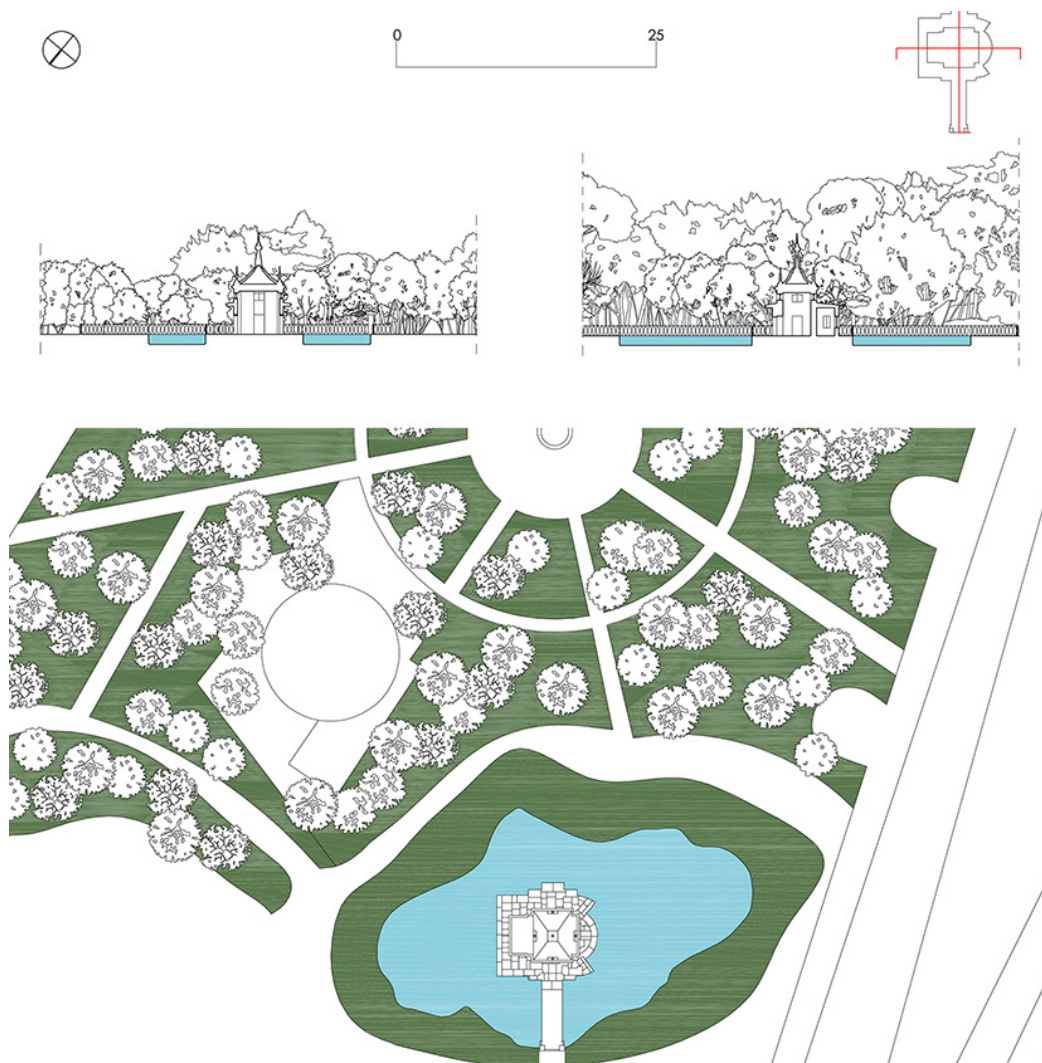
Il Parco del Retiro a Madrid, la *Casita del Pescador*, pianta delle coperture, sezione A-A' (a sinistra), sezione B-B' (a destra).
